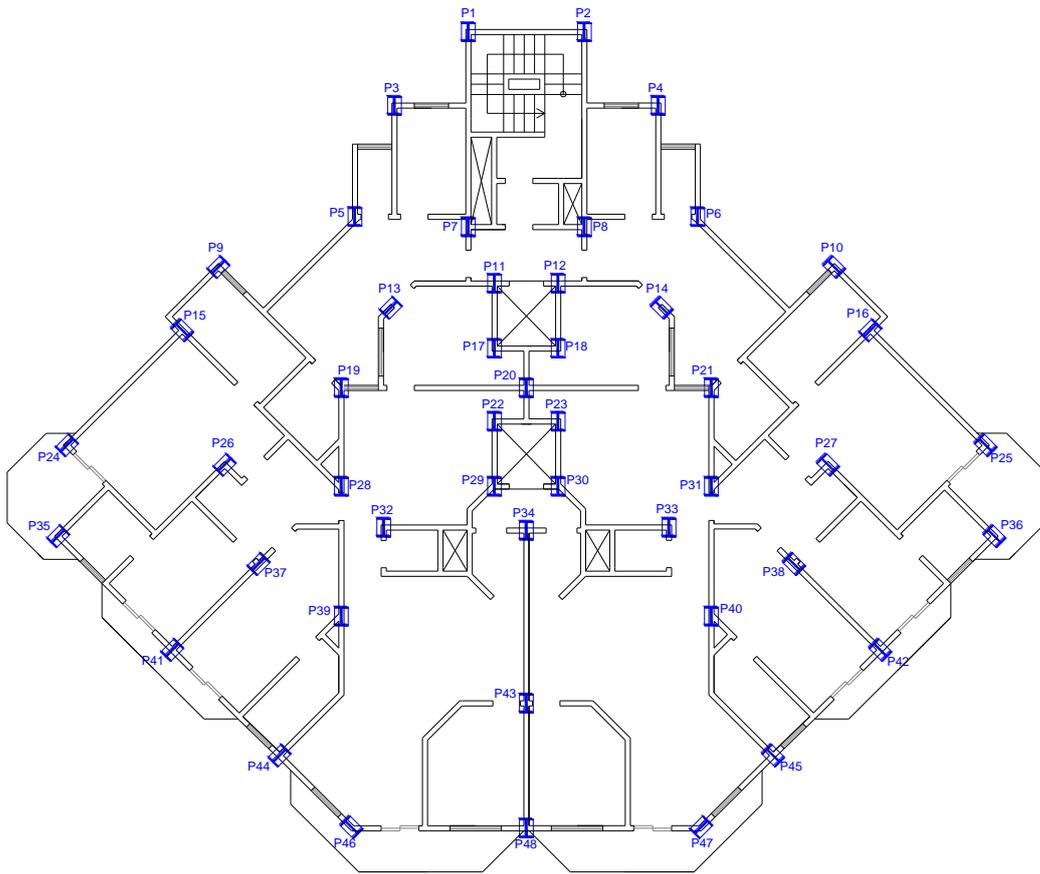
Localização dos pilares de aço em planta – Residencial San Marcos.
